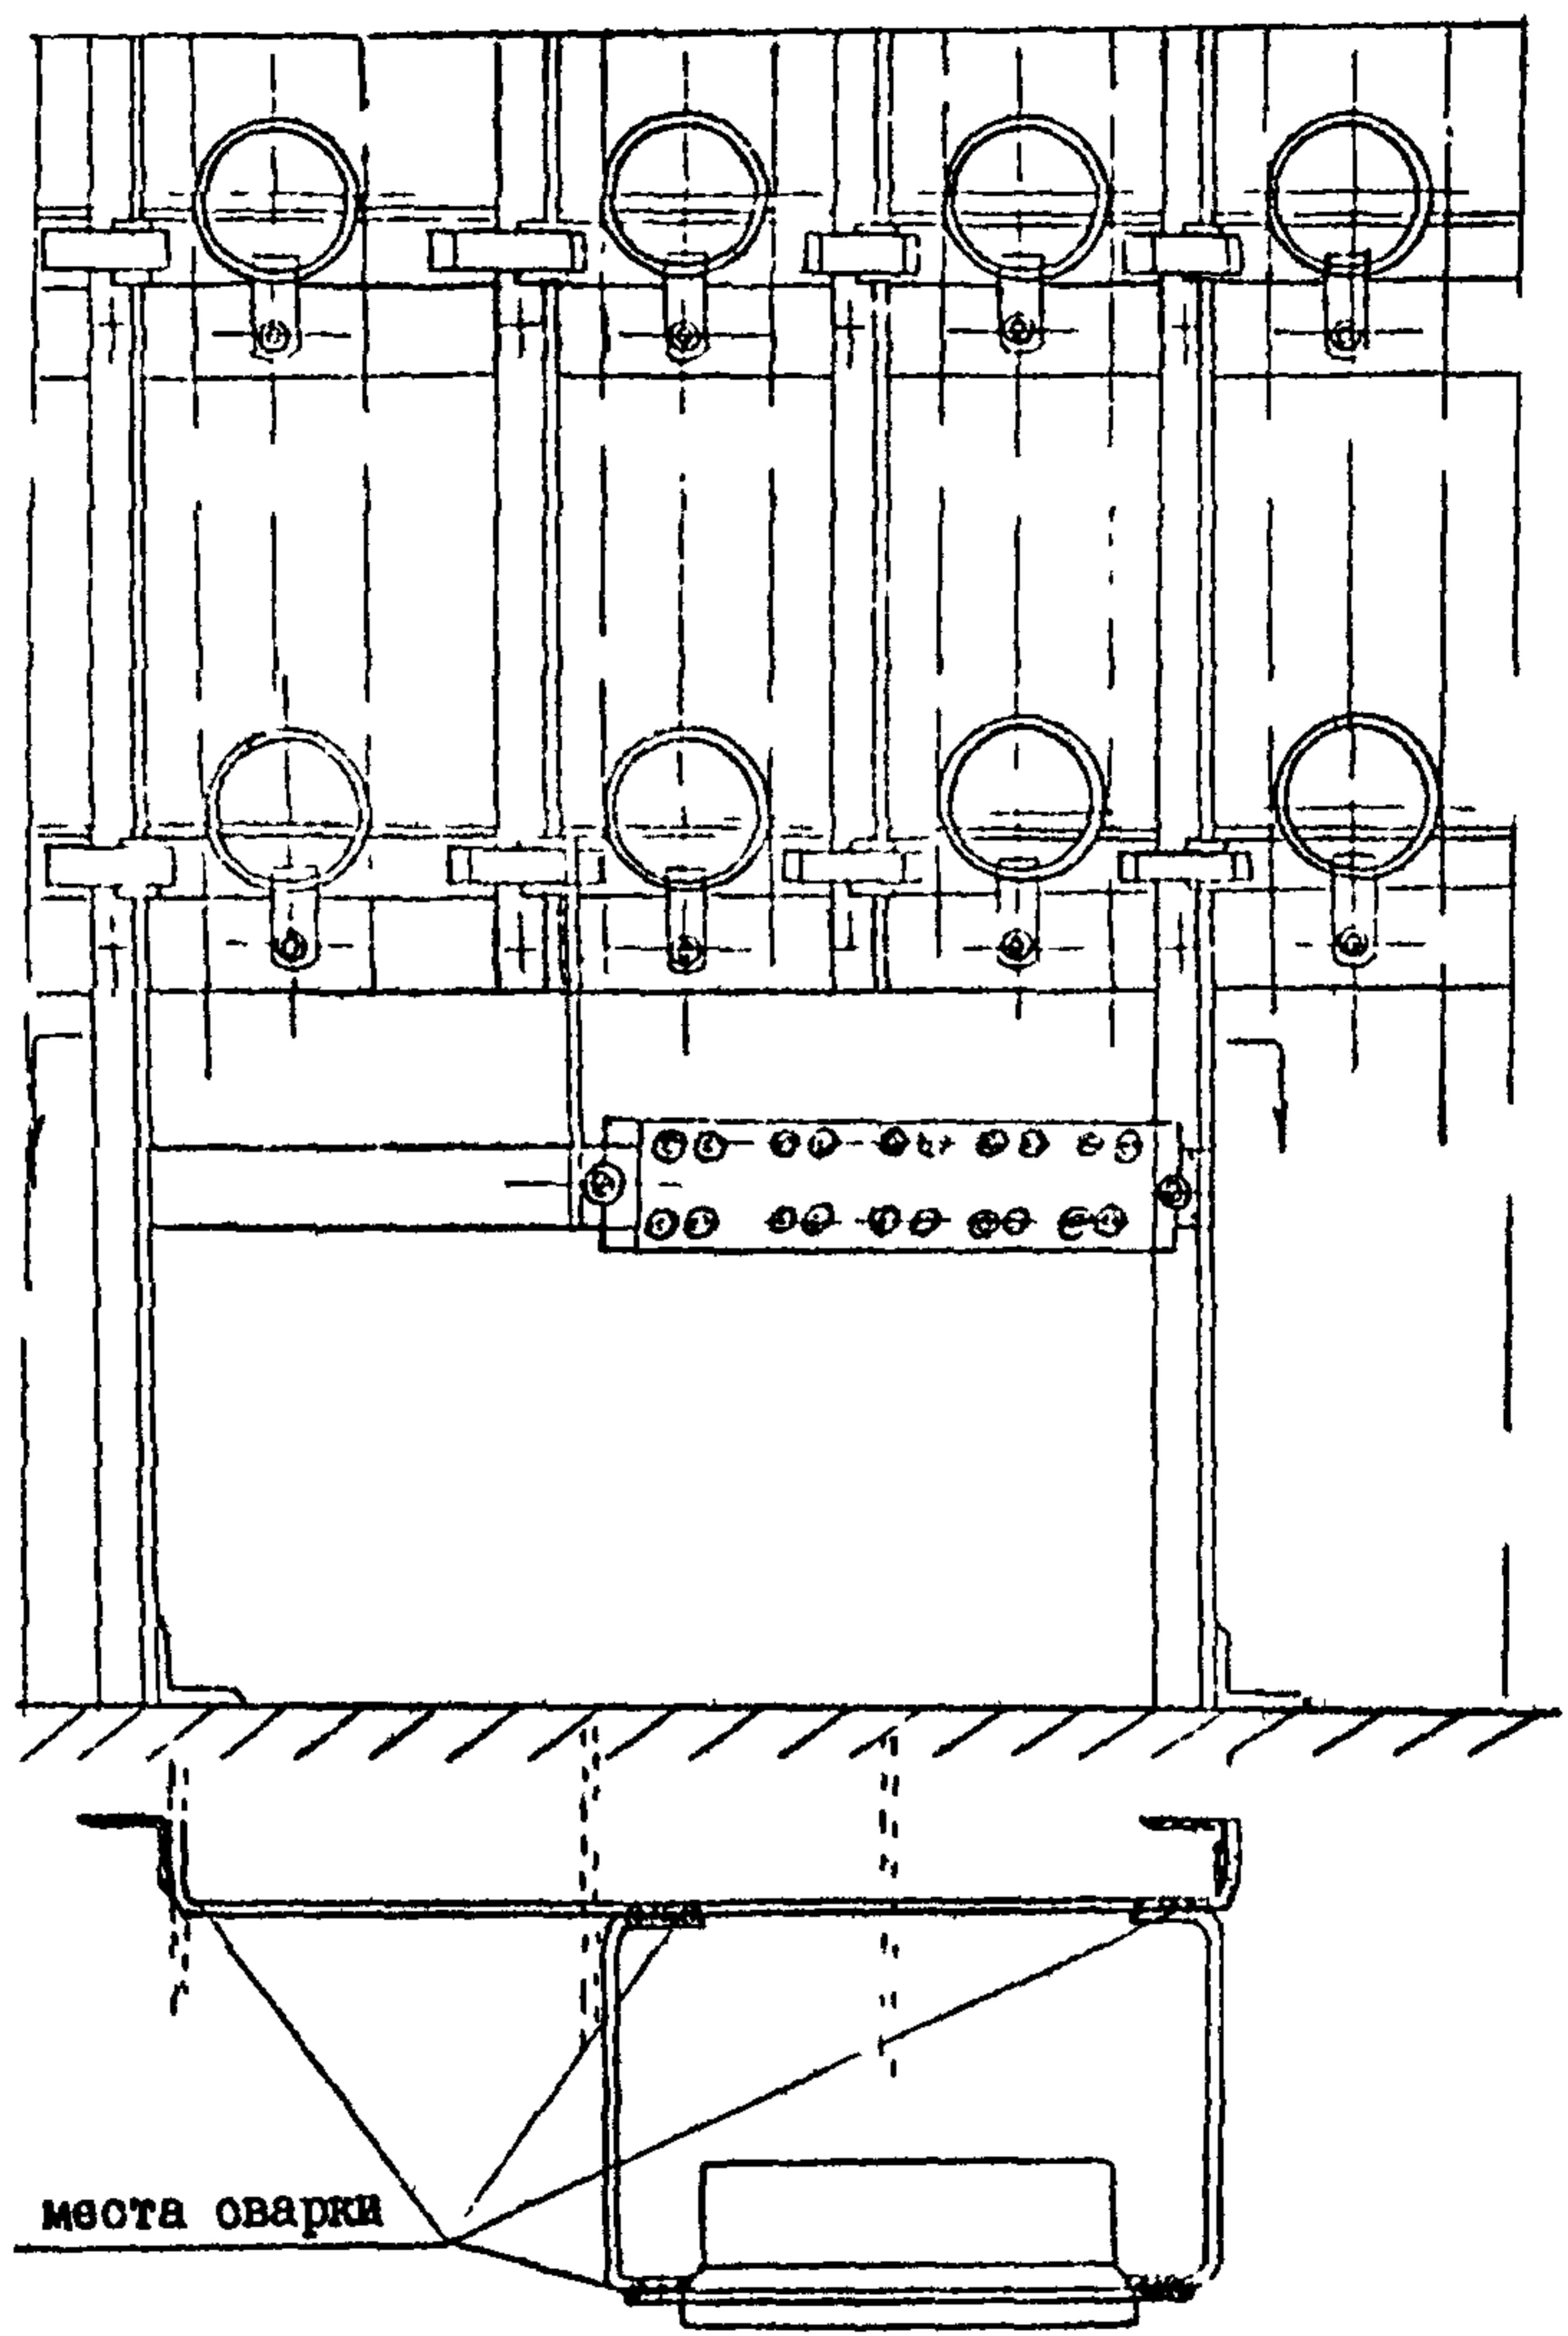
Крепление рамки с испытательными гнездами в абонентском кроссе
